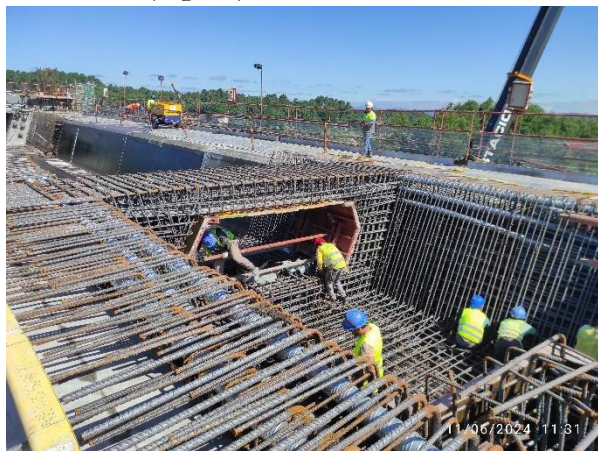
Ferrallado de la zona del diafragma de pila y de la zona de frente de fase.
